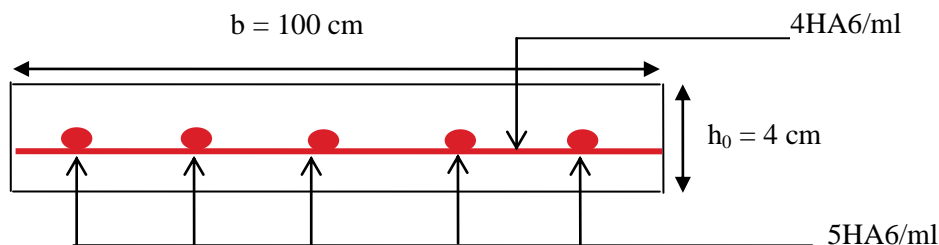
Schéma de ferrailage de la dalle de compression
